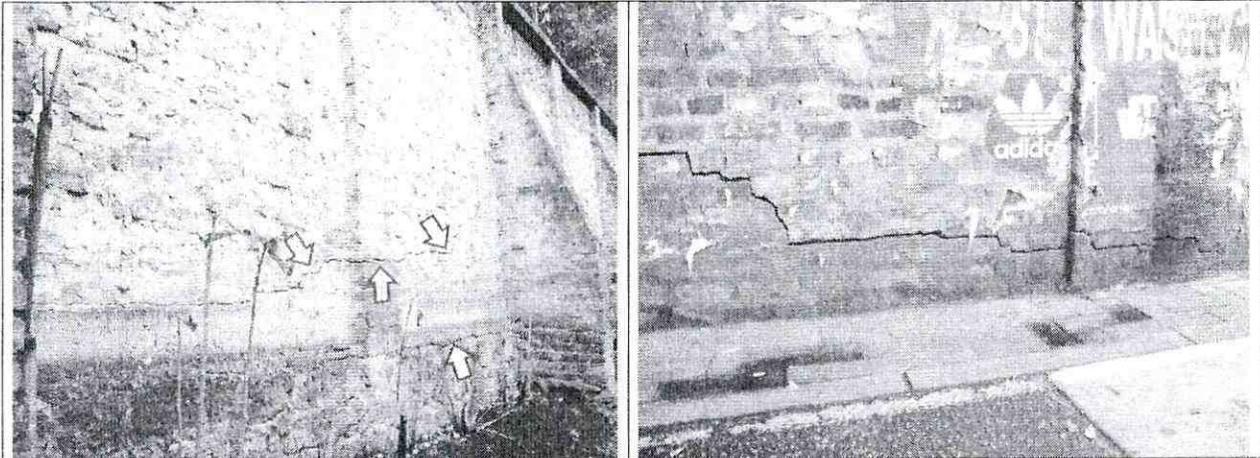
Vista exterior del sector oriental del muro del costado norte, el cual presenta columnas, contrafuertes y viga de concreto reforzado.
